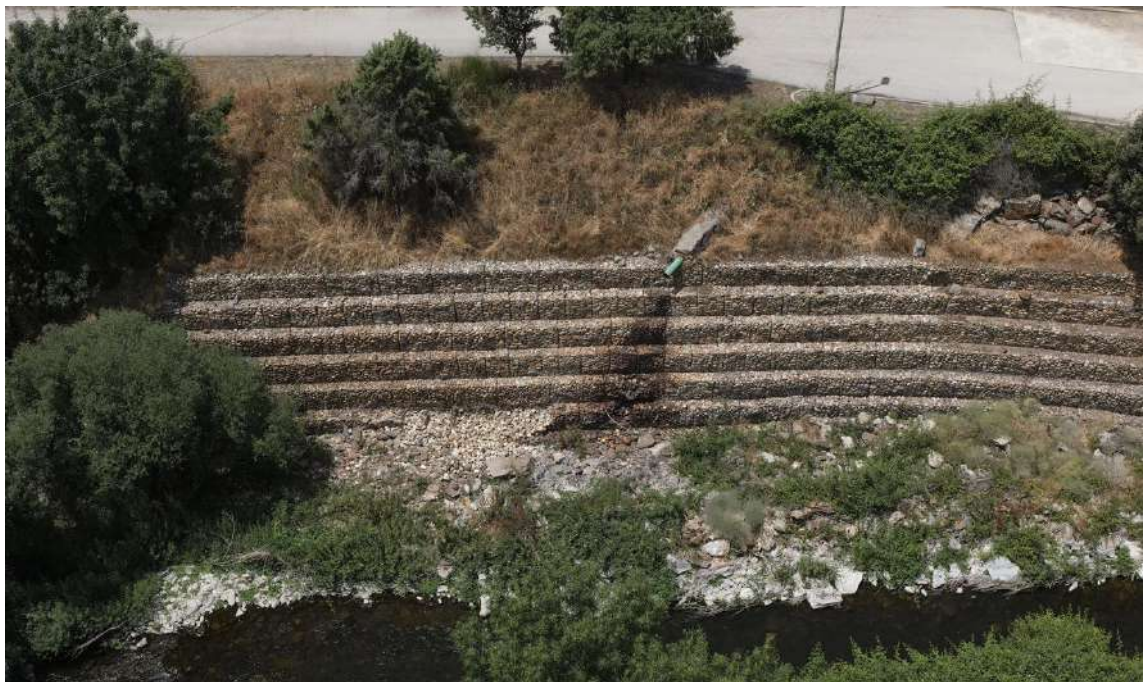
Zona del muro de gaviones no desprendido a lo largo del talud
